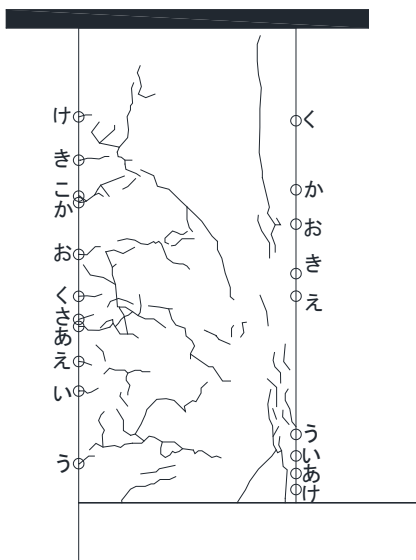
柱ひび割れ幅測定位置(試験体 C-3 正載荷)
